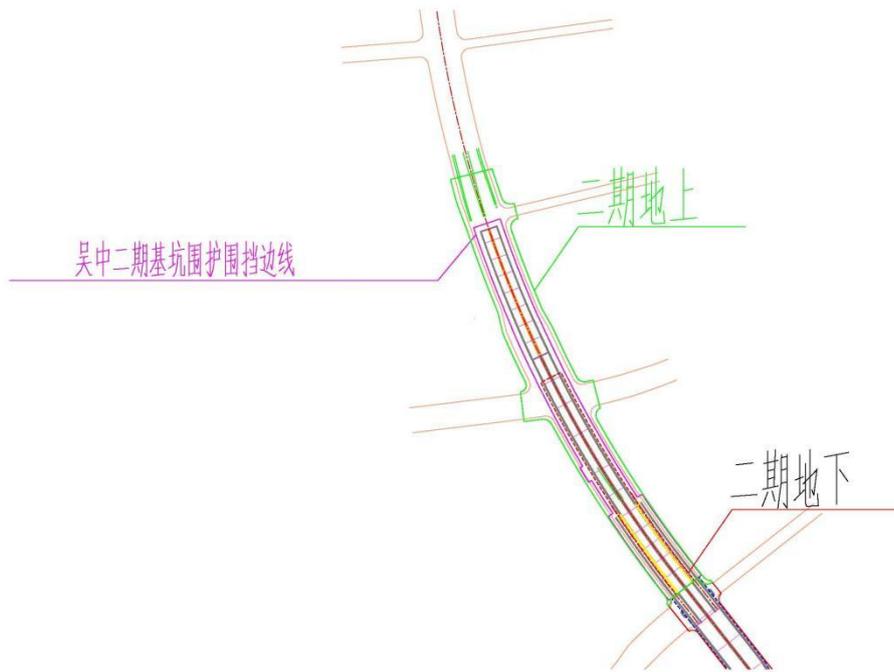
东太湖隧道二期工程（吴中段）平面布置示意图
